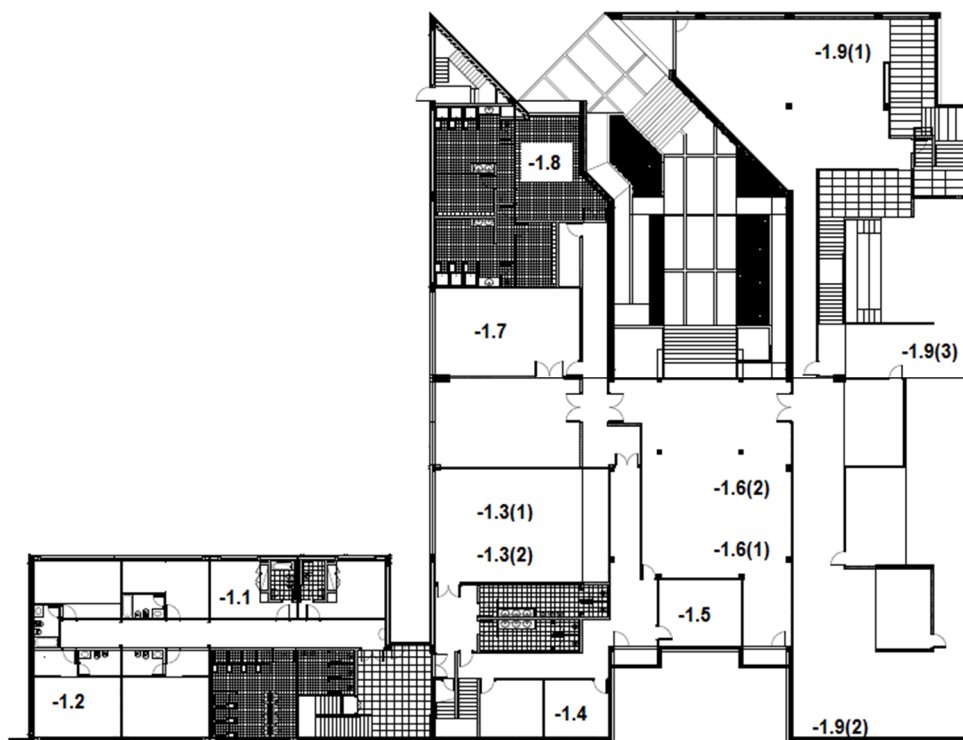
Descrição da localização dos pontos de medição em planta para o piso inferior.
